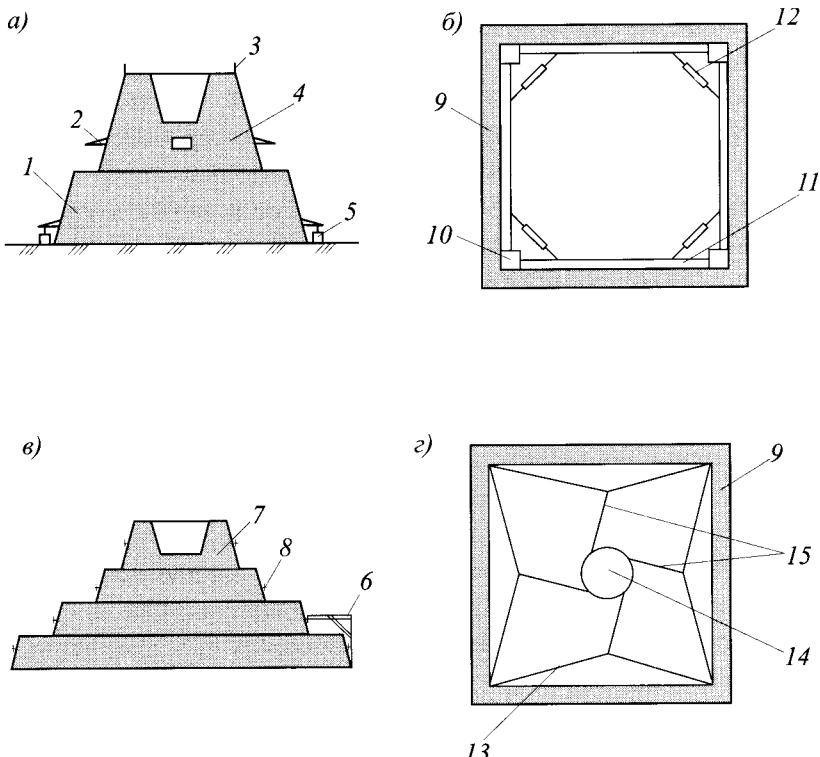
Блок-формы и блочные опалубки: *а* - неразъемные блок-формы фундамента; *б* - разъемная блок-форма фундамента; *в* - крупноблочная опалубка со стяжными муфтами; *г* - то же с гибкими щитами; 1 - блок подколонника; 2 - кронштейн для упора домкратов; 3 - монтажная петля; 4 - блок ступени фундамента; 5 - домкрат; 6 - отрывное устройство; 7 - замок; 8 - блок-форма стороны фундамента; 9 - бетонируемая конструкция; 10 - элемент каркаса опалубки; 11 - щит опалубки; 12 - стяжная муфта; 13 - гибкий щит опалубки; 14 - центральная поворотная стойка; 15 - тяги к щитам
